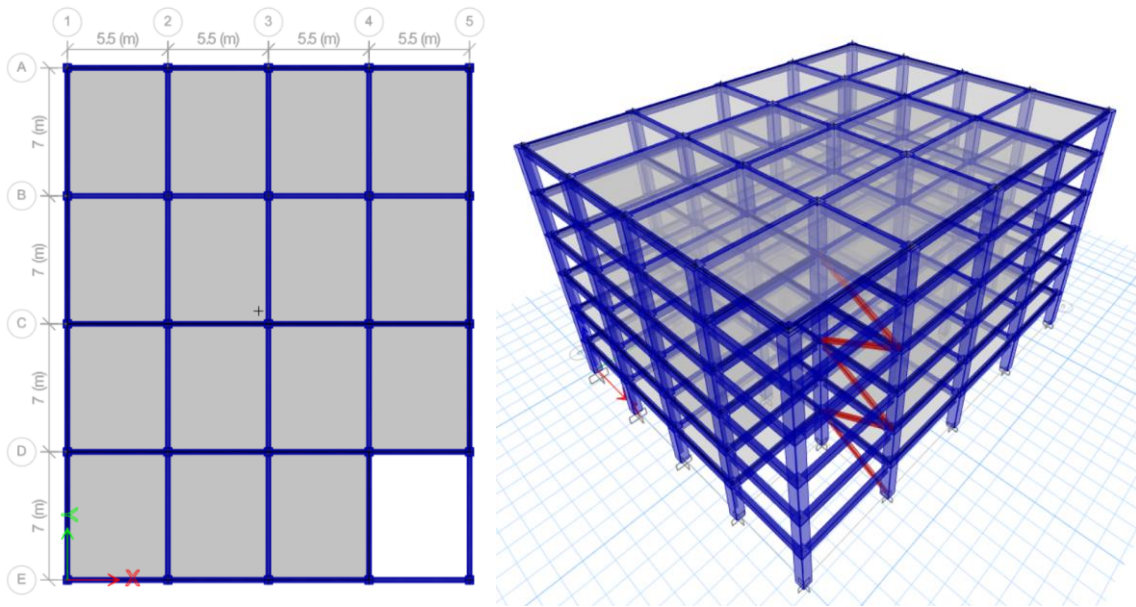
Vista en planta y en 3D de modelo estructural Caso 1.
